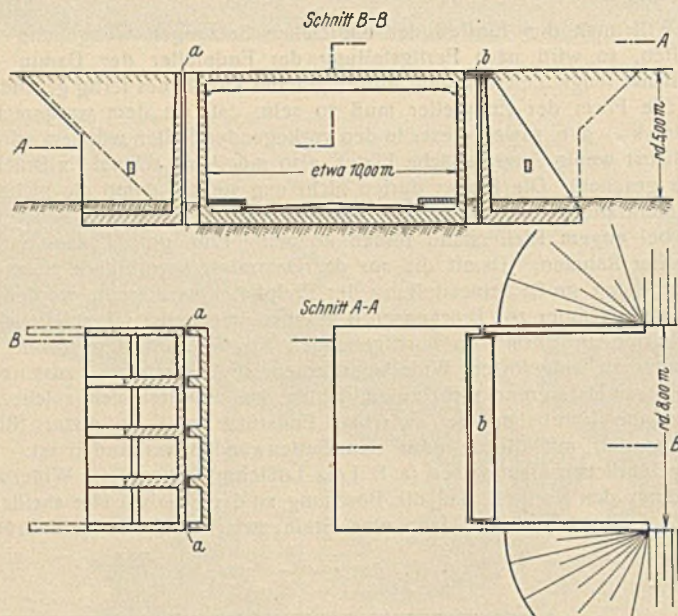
Geschlossener Rahmen mit getrennten Erddruckstützmauern bei Flachgründung auf weichem Untergrunde.
